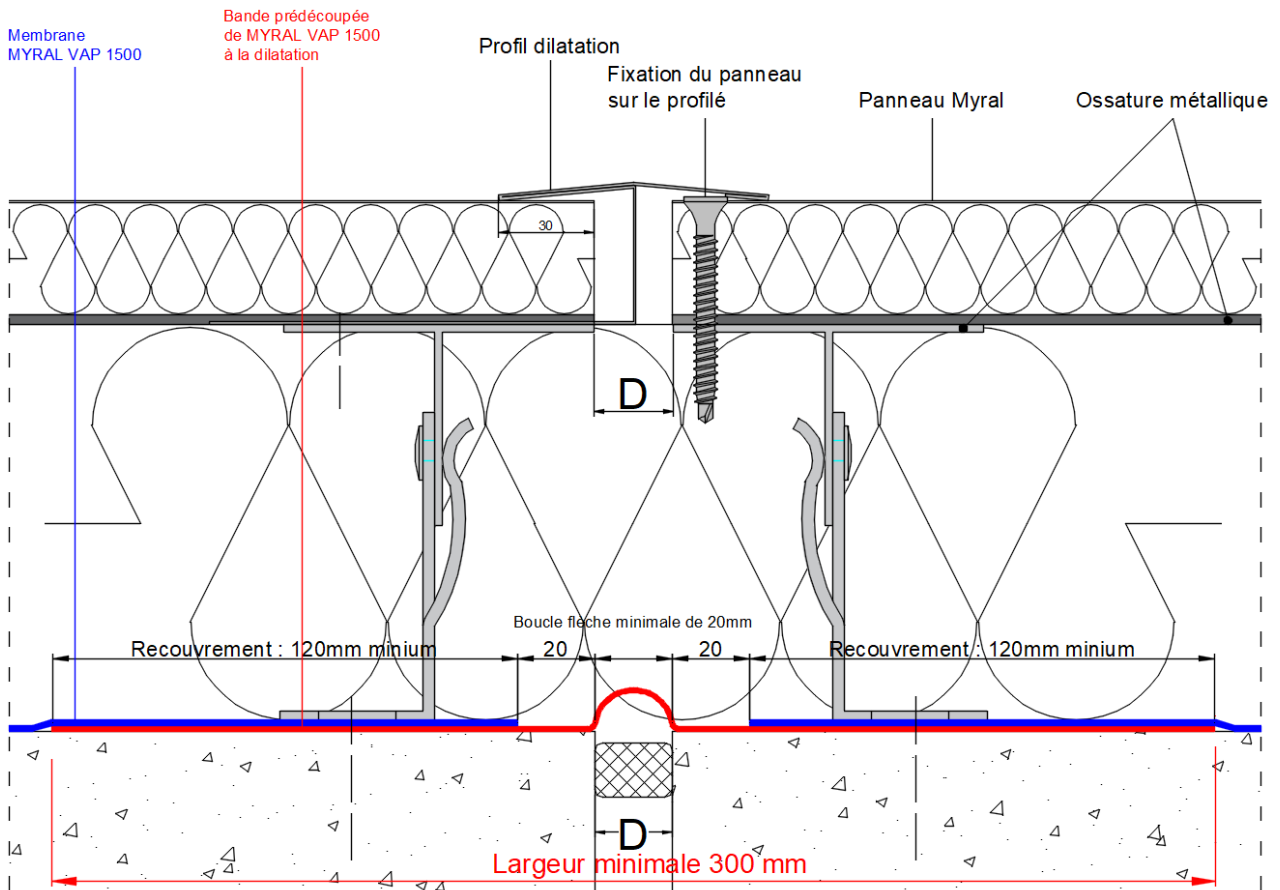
Joint de dilatation du gros œuvre - Coupe horizontale
